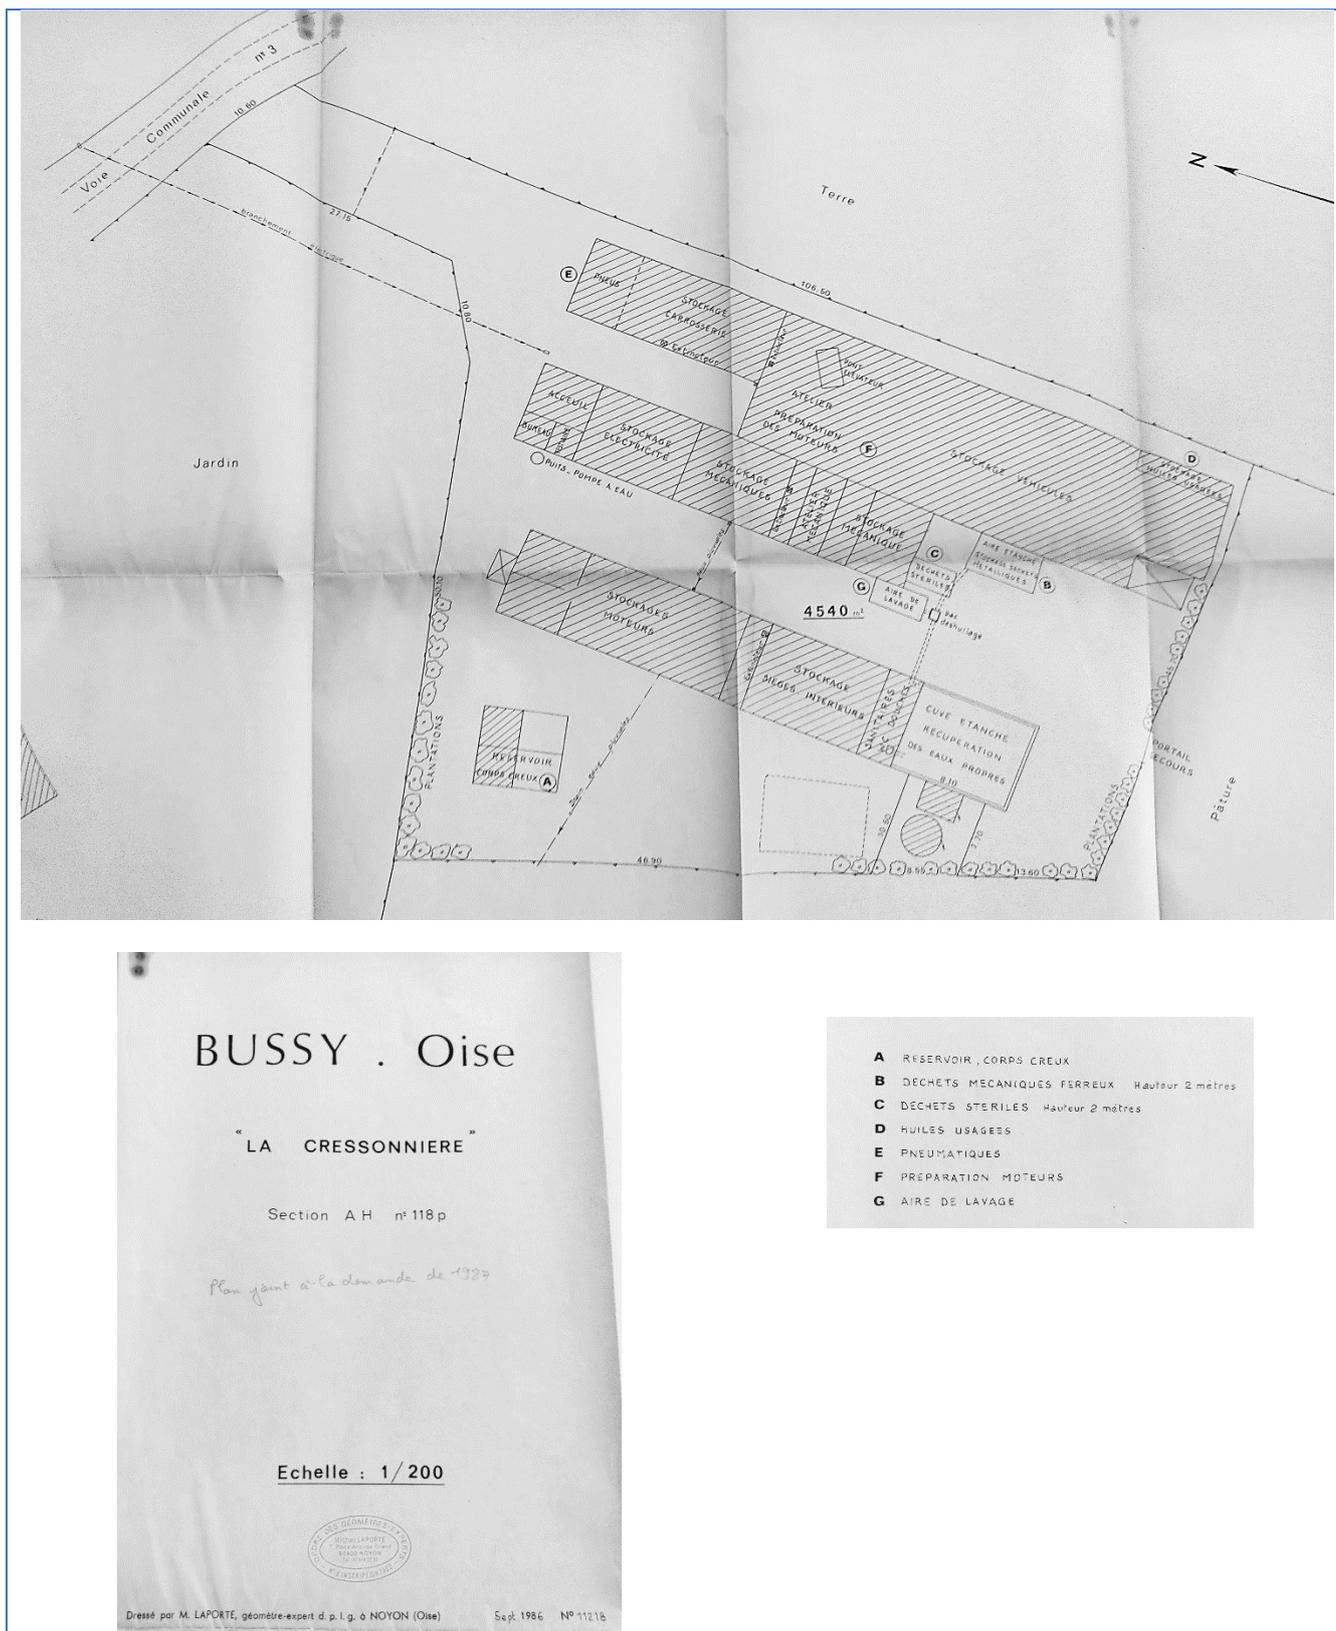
Copie (sans échelle) du plan d'ensemble associé à l'arrêté d'autorisation du 17 mai 1988 (échelle d'origine : 1/200)
